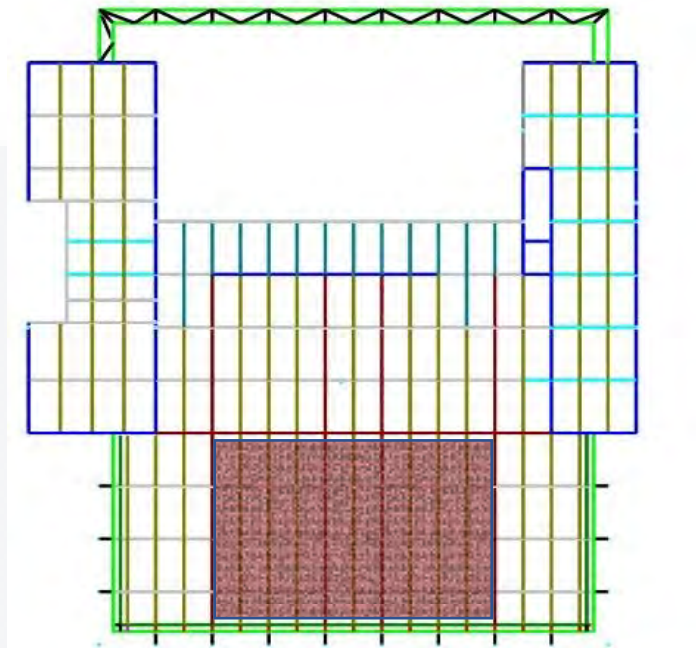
3. Ubicación del modelo estructural en referencia a planta estructural de salón de eventos.
